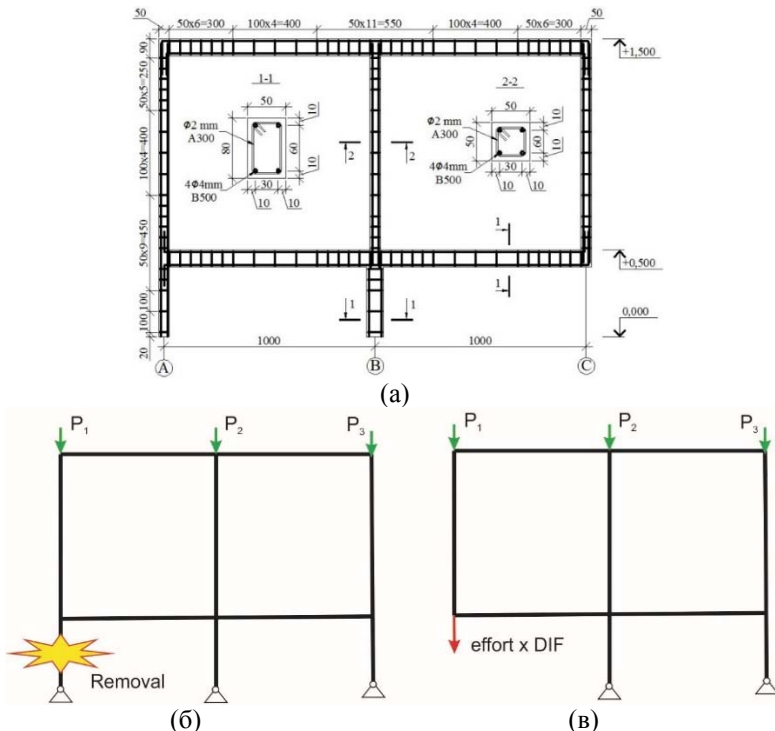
Масштабная модель рамы: а) схема армирования 2D-модели железобетонной рамы; б) первичная расчетная схема «n»; в) вторичная расчетная схема «n-1»
